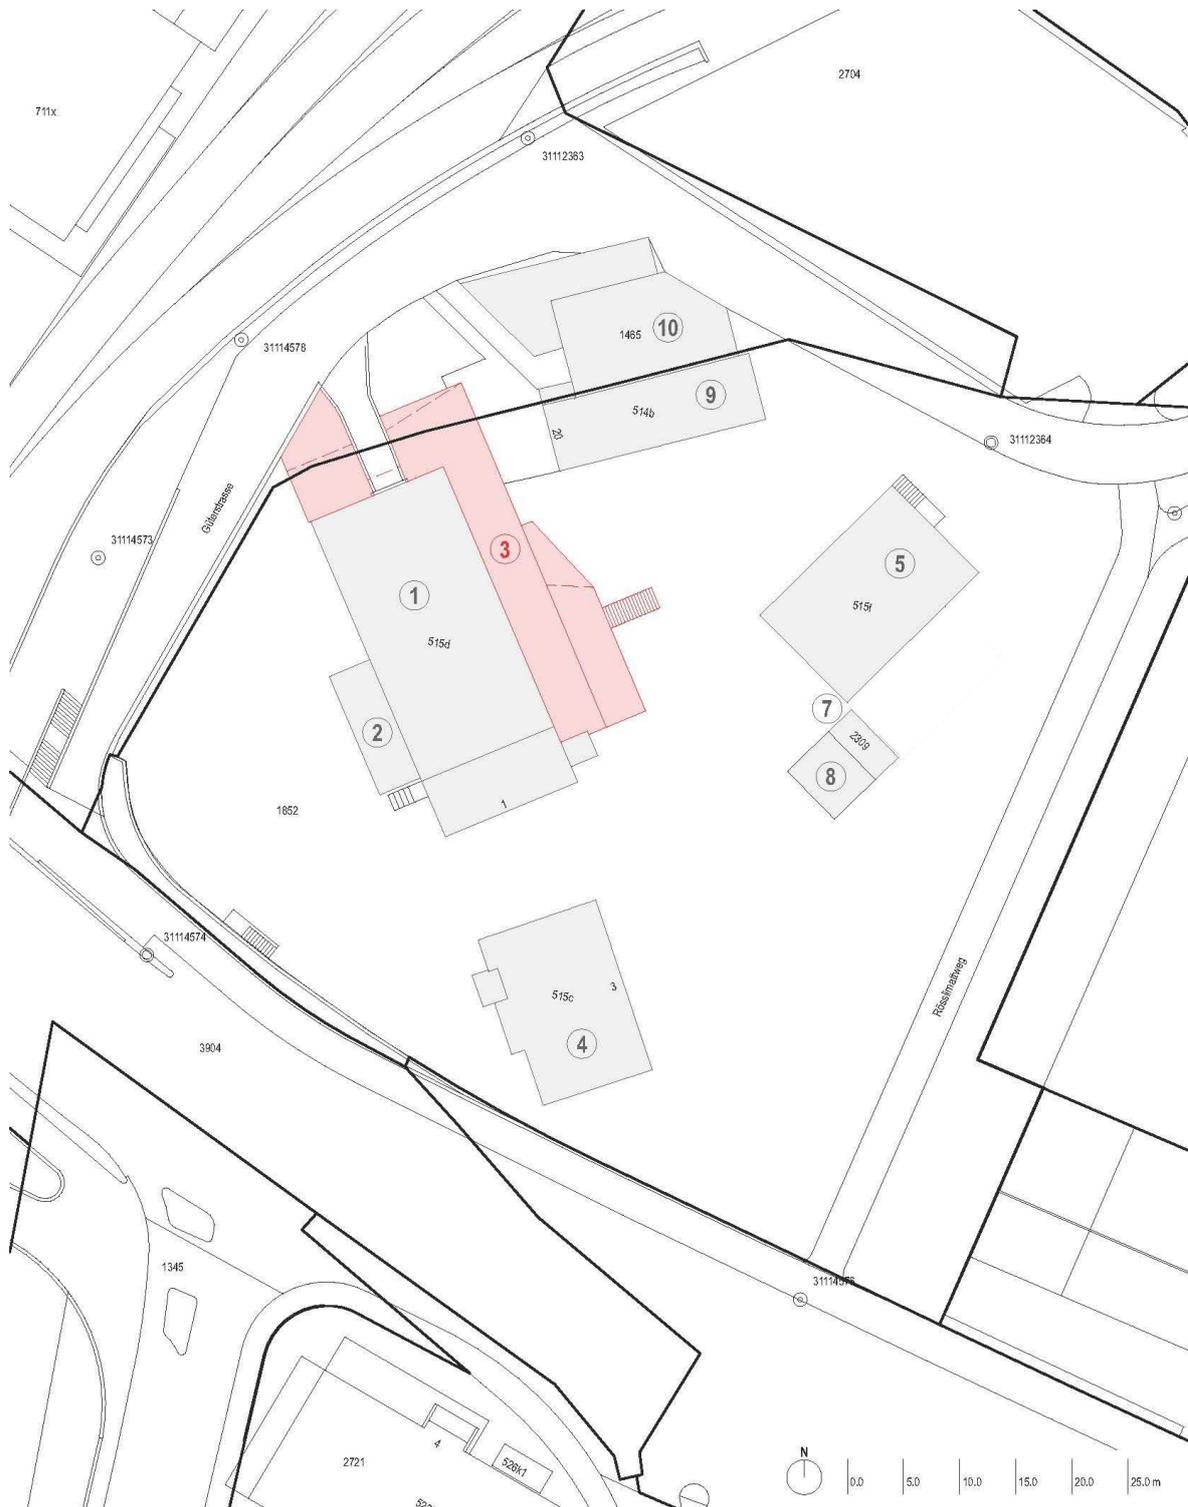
Situationsplan mit Erweiterung (Legende: 1 und 2 Schür bestehend; 3 Schür Erweiterungsbau neu; 4 vermietetes Gebäude; 5, 7, 8 Gebäude Stadtgärtnerei; 9 vermietetes Gebäude; 10 Eigentum SBB)
